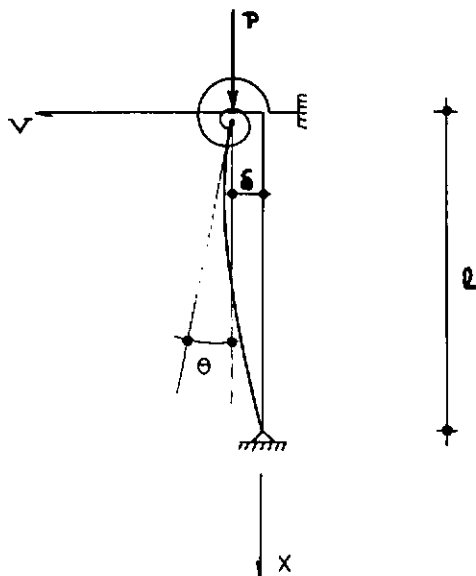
Pilar isolado do pórtico para determinação do comprimento de flambagem
